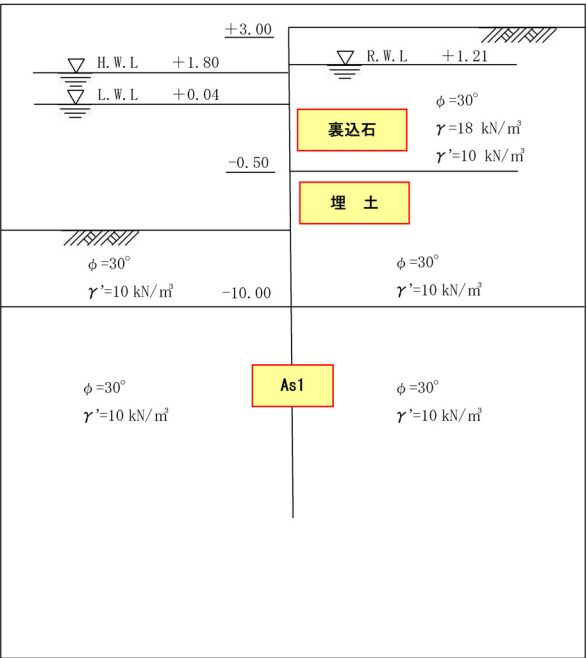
地盤モデル図 (A, B, C, F 断面)
